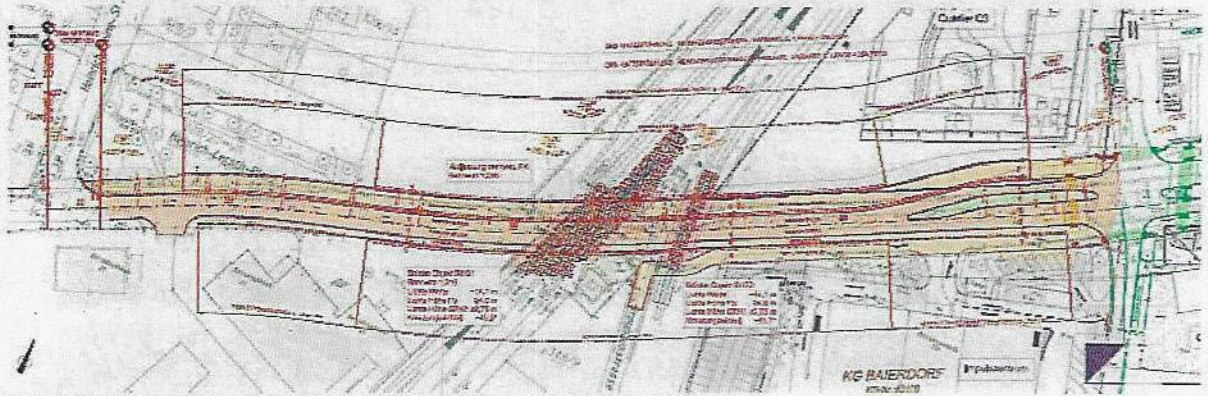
Straßenunterführung Reininghausstraße (Planung BHM Ingenieure)
